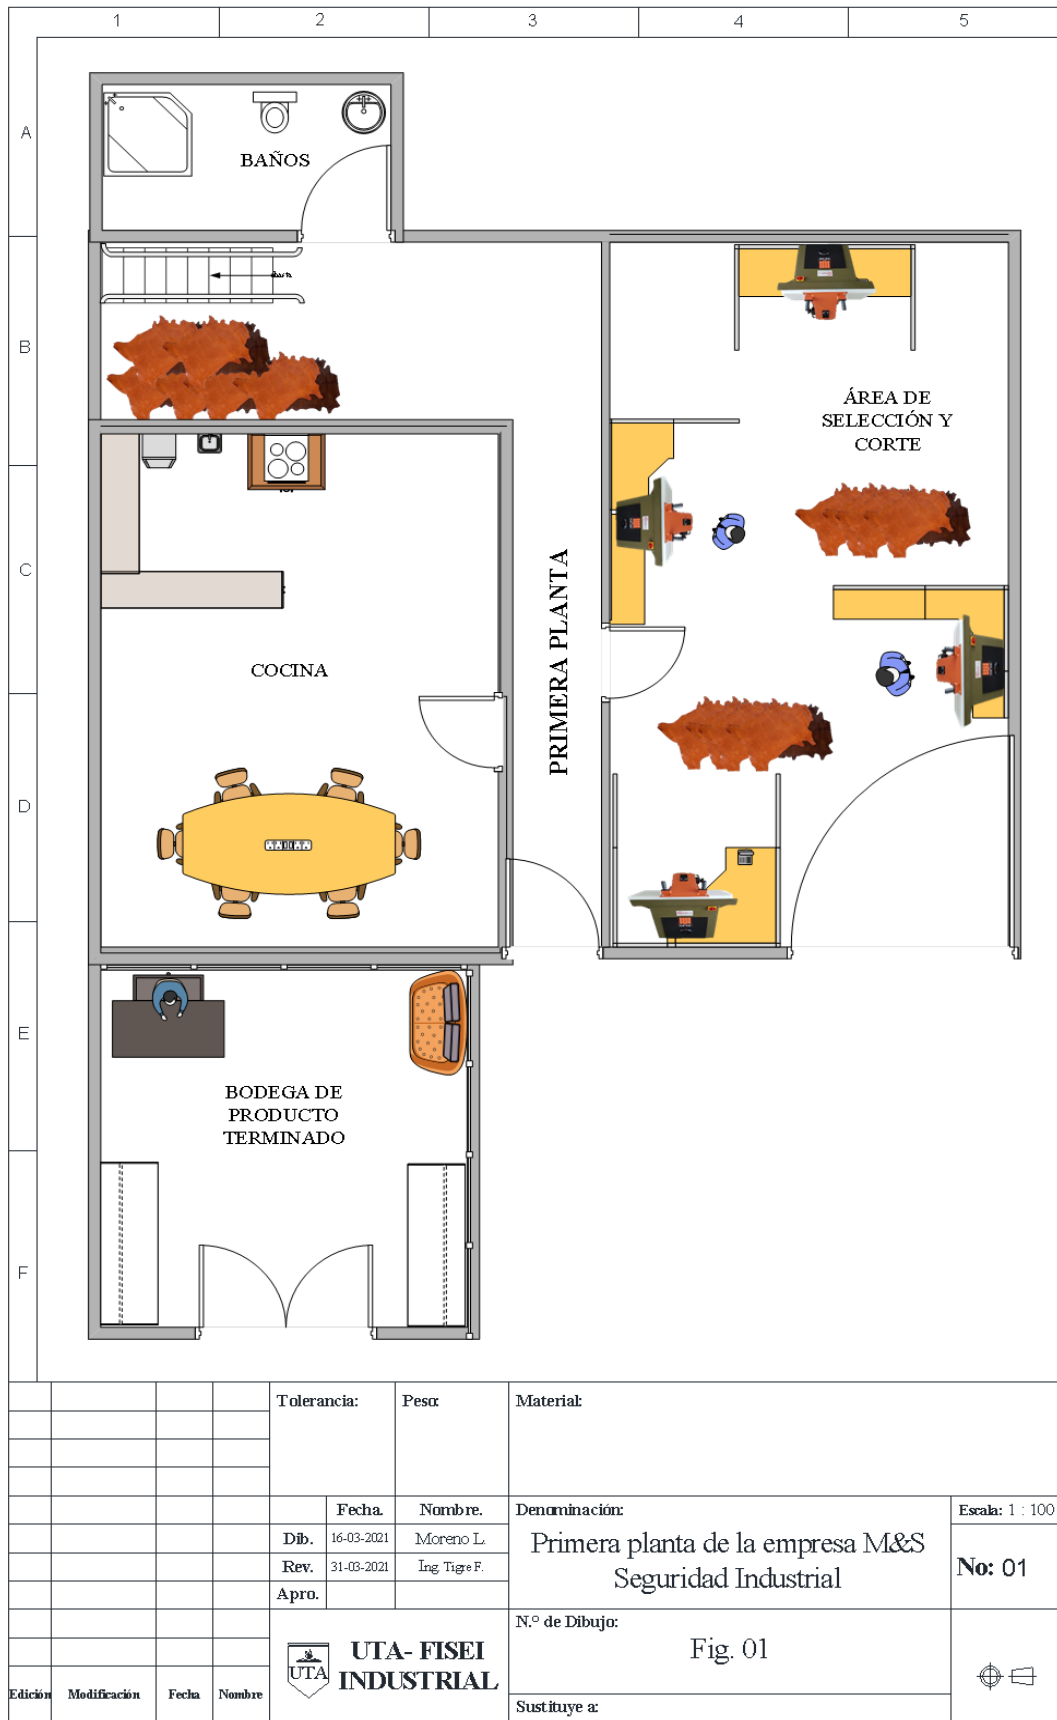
Layout de la primera planta de la empresa M&S Seguridad Industrial
